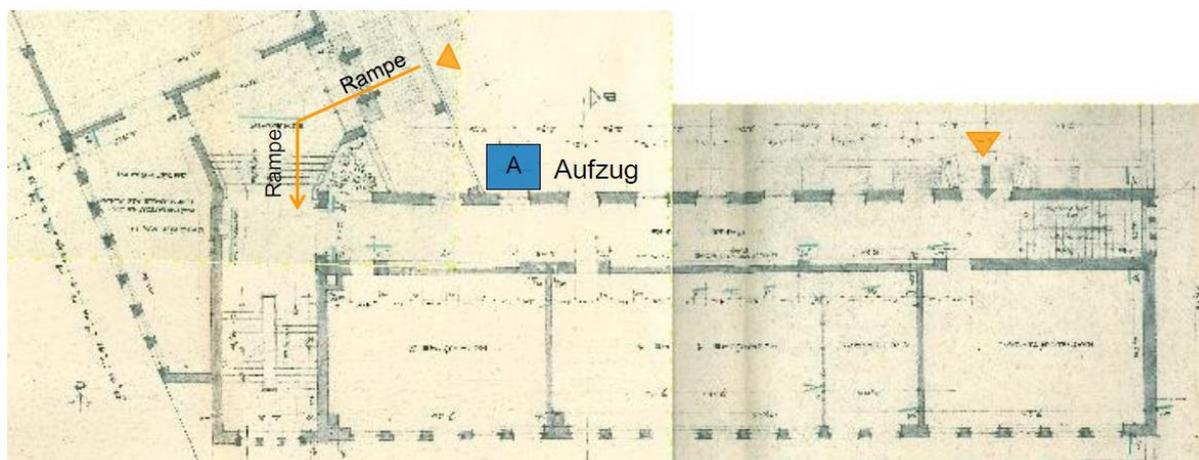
Mögliche Anordnung von Aufzug und Rampen im Grundriss
